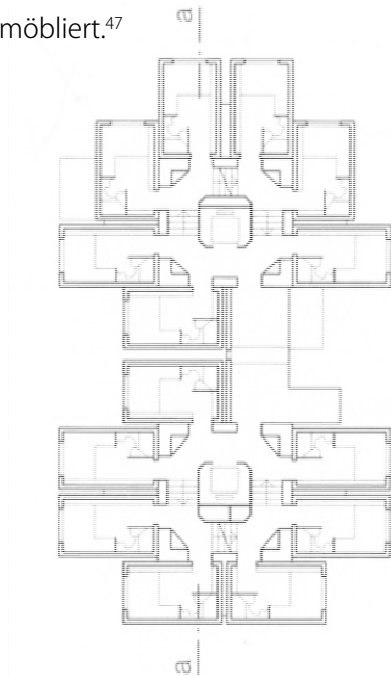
Grundriss Nakagin Capsule Tower
